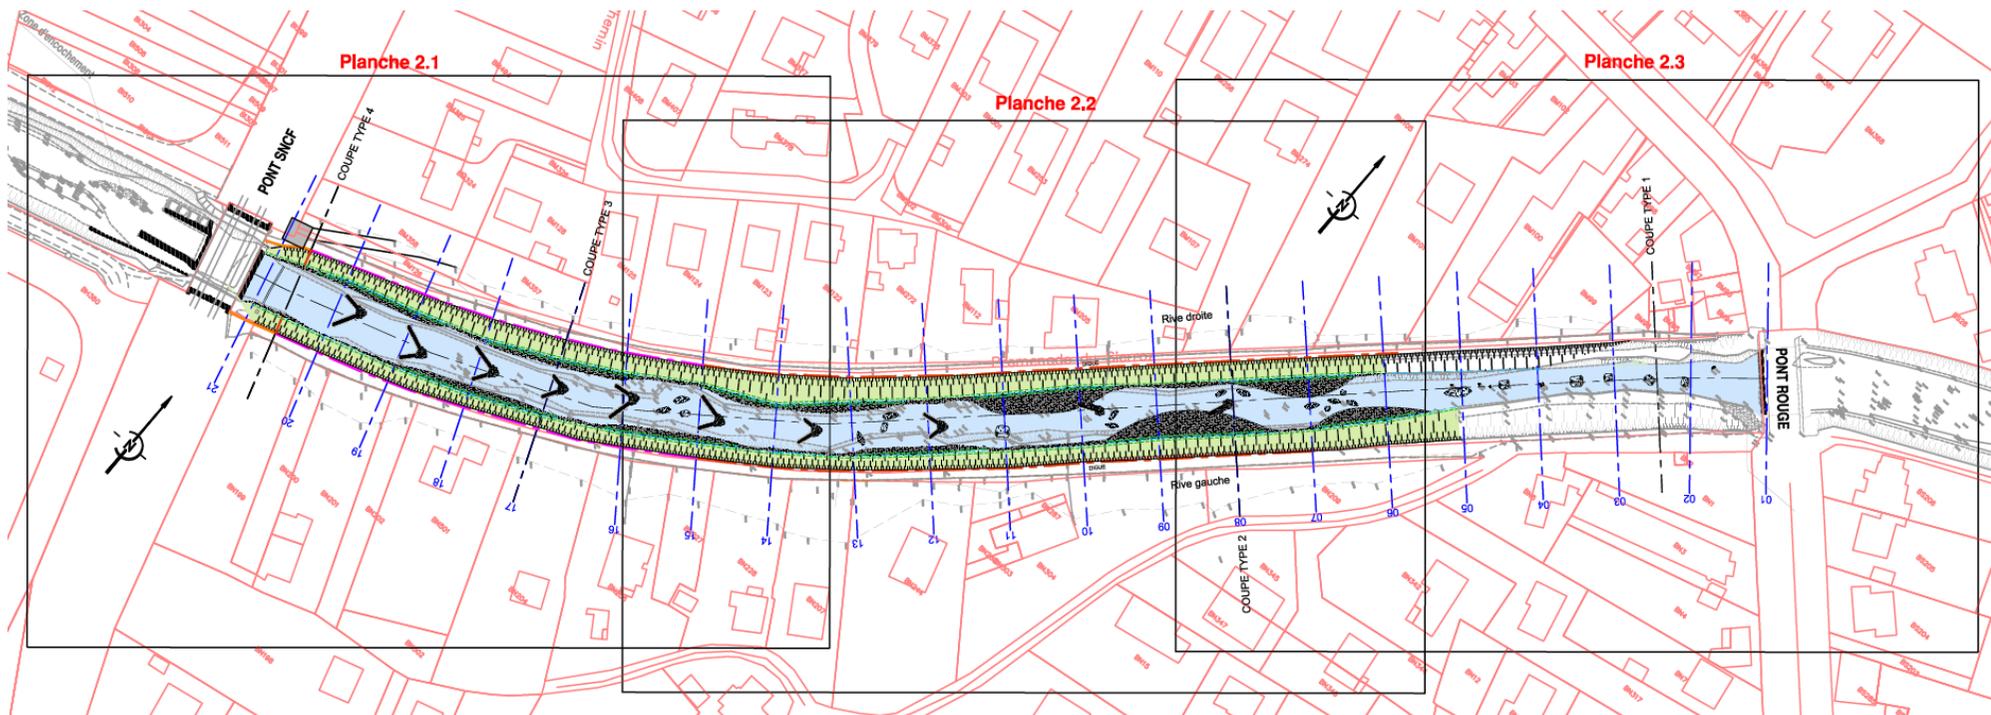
Vue d'ensemble des travaux de confortement prévus sur le Sierroz et situation des planches de détail
